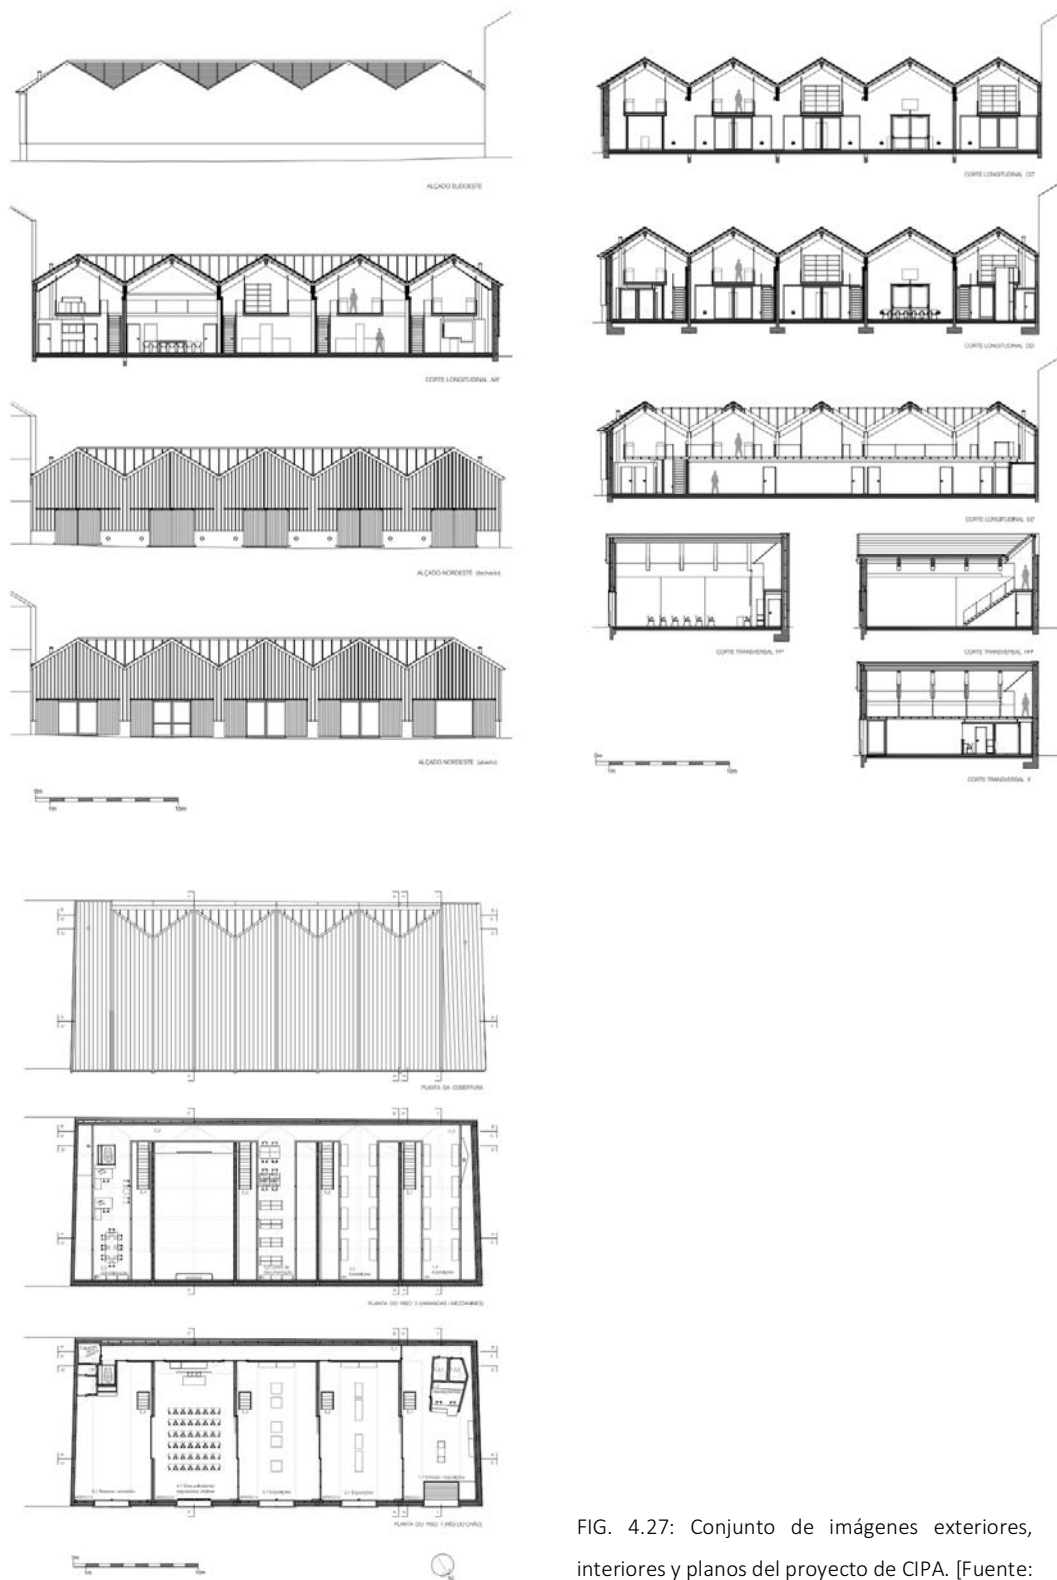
Conjunto de imágenes exteriores, interiores y planos del proyecto de CIPA. [Fuente: Archivo del arquitecto Sérgio Fernandez]
